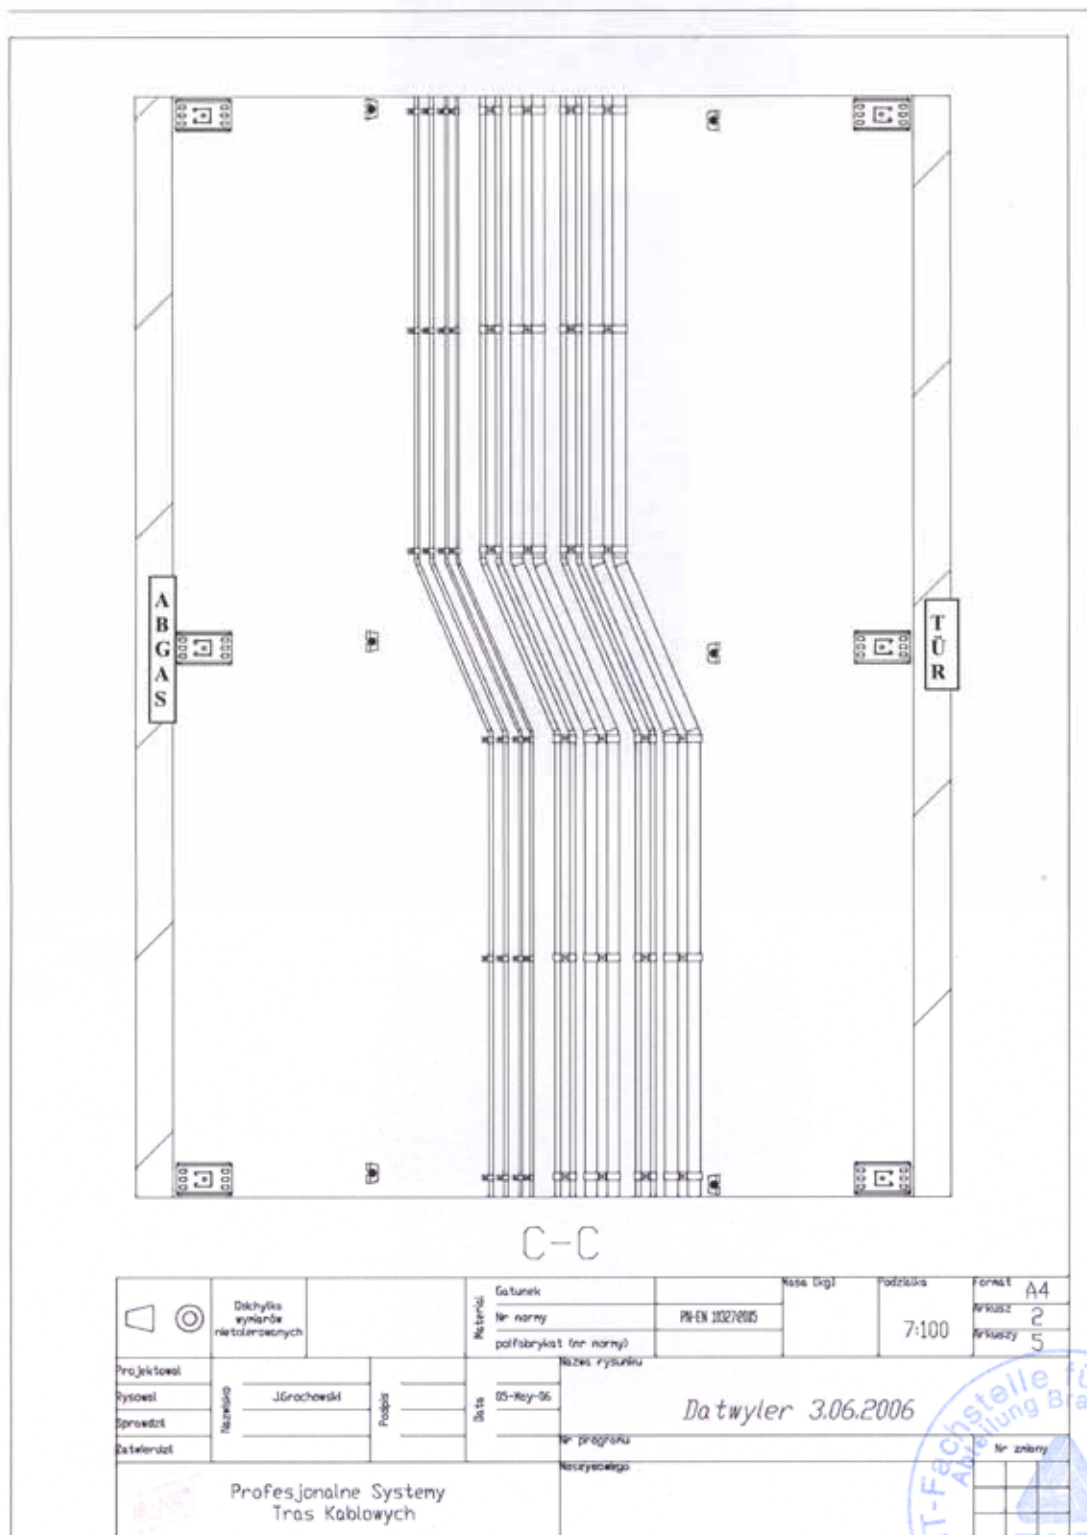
Grundriss der montierten Tragsysteme
